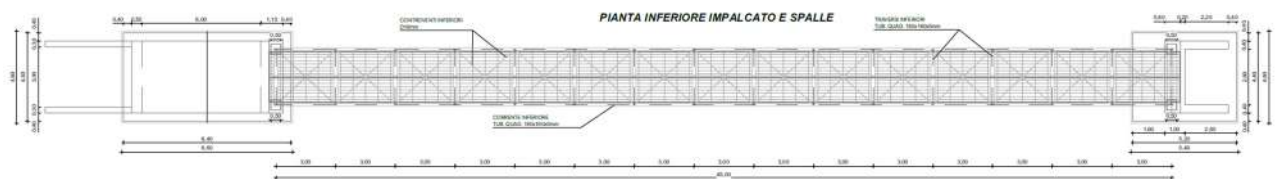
Passerella ciclopedonale – Pianta strutturale inferiore
